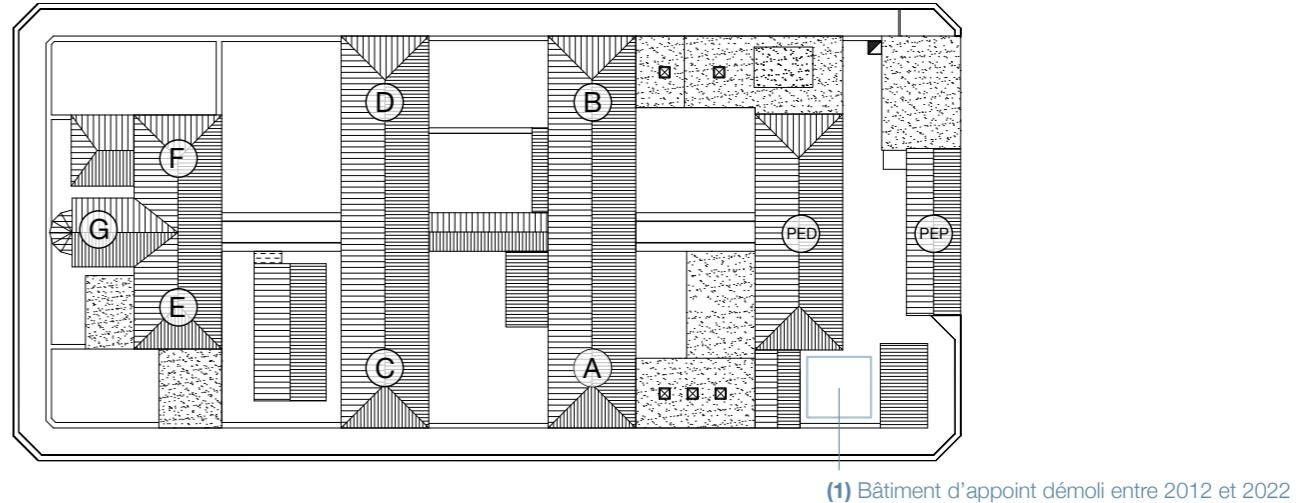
Plan de toiture existant en 2022, d'après photographie aérienne. Source : Croisée d'archi.
